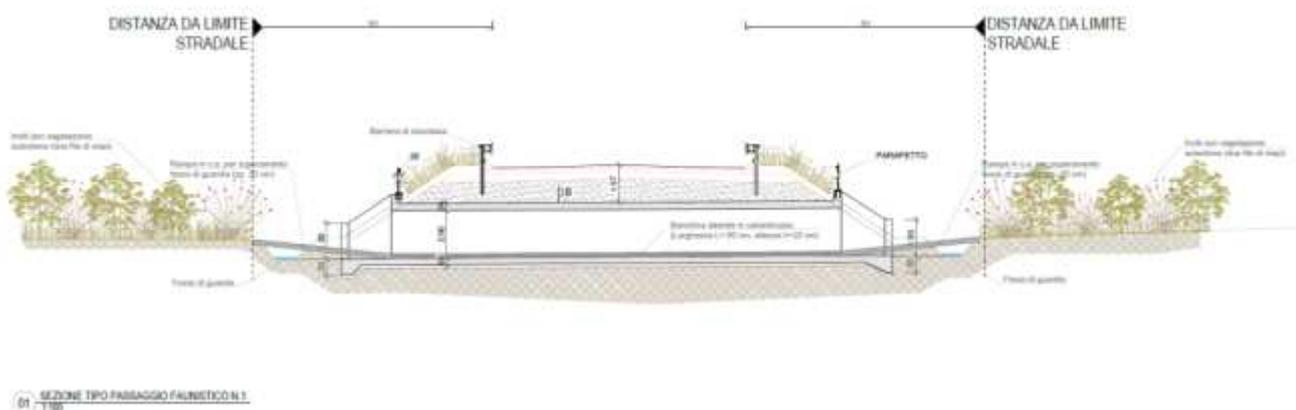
Sezione longitudinale attraversamenti faunistici
